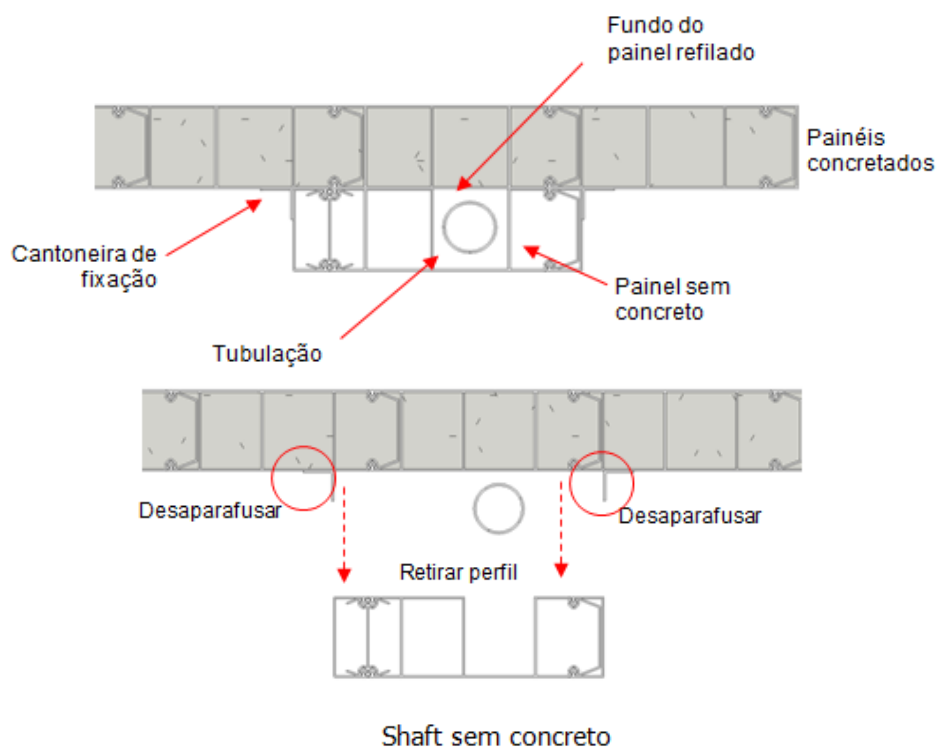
Exemplo de shaft construídos com os perfis de PVC rígido do Sistema Construtivo Basse PVC. (Sem escala).
